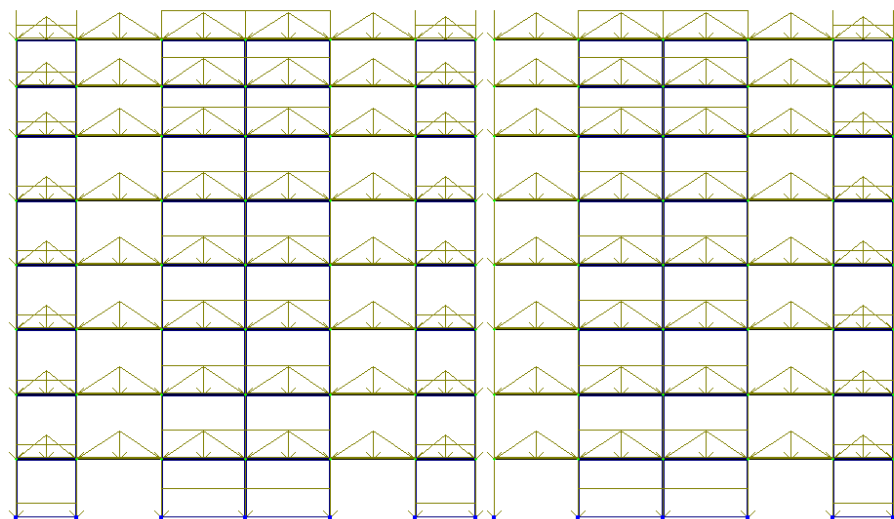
Схема завантаження, від постійного навантаження
